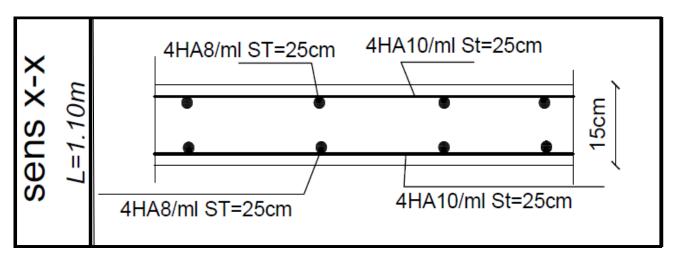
plan de ferraillage de la salle machine suivant x-x
